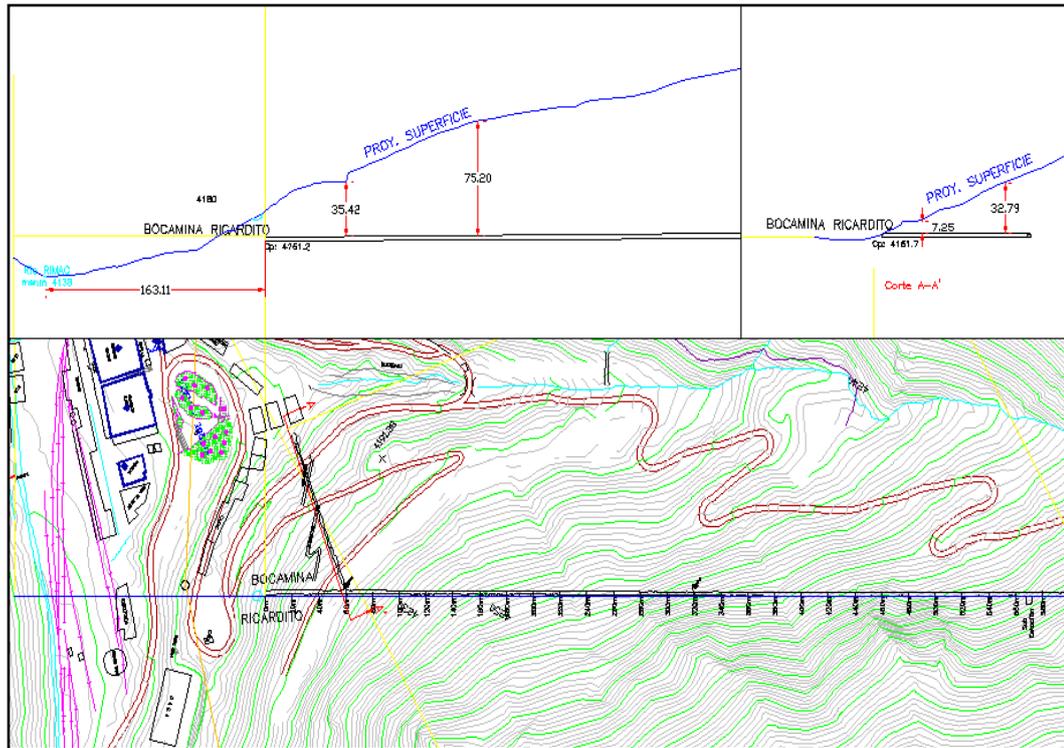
Ruta de acceso a los horizontes vista de planta por el túnel Ricardito
